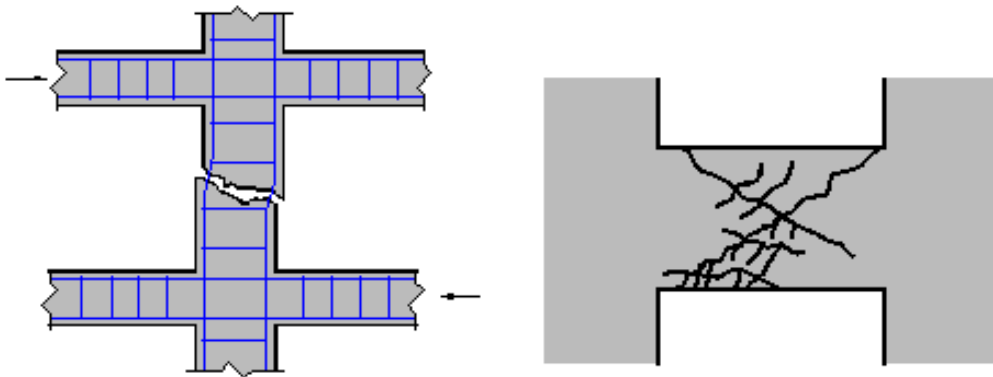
Falla por Corte en columna gruesa (izq.) y en viga corta (der.)
